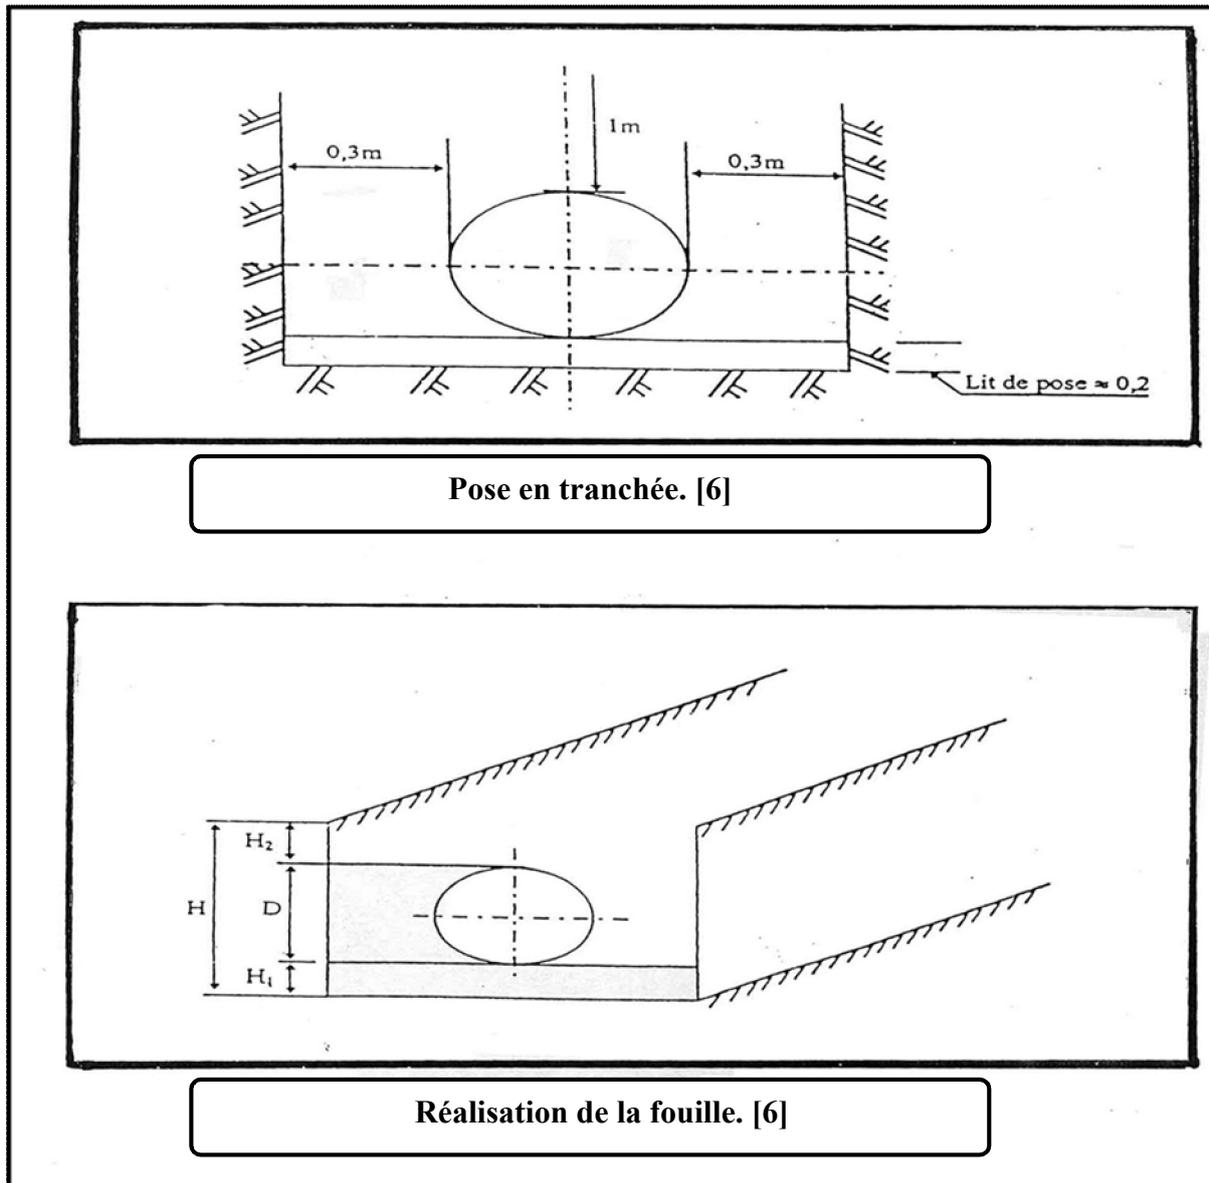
Schéma d'une tranchée avec une conduite circulaire
